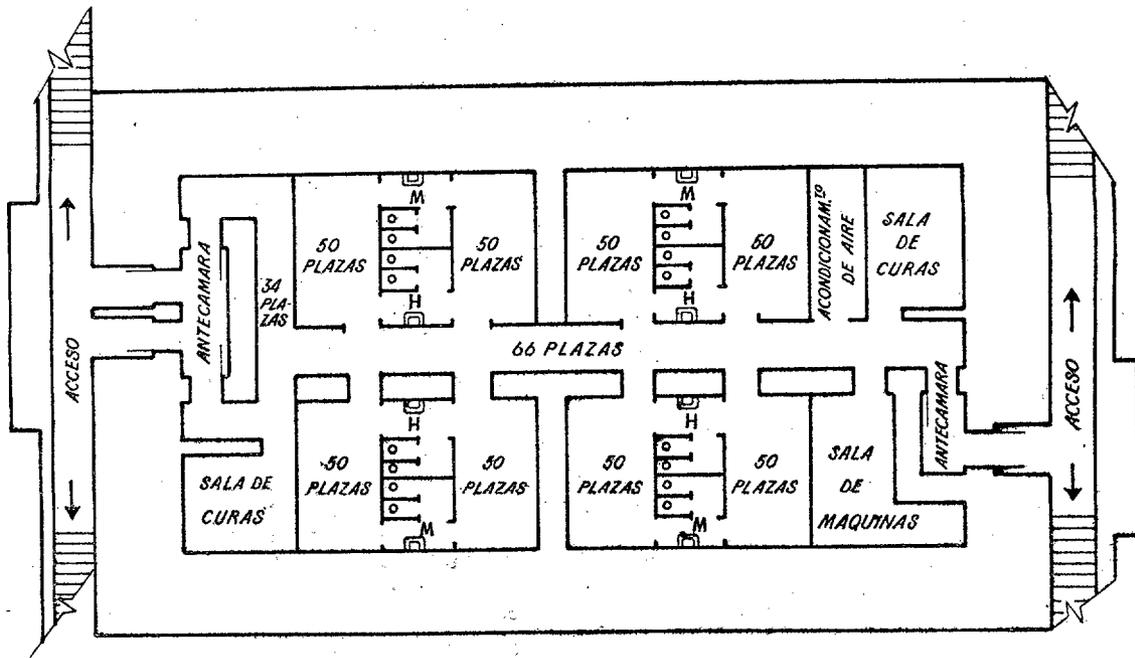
PLANTA TIPO DE REFUGIO REFORZADO PERMANENTE PARA 500 PLAZAS
